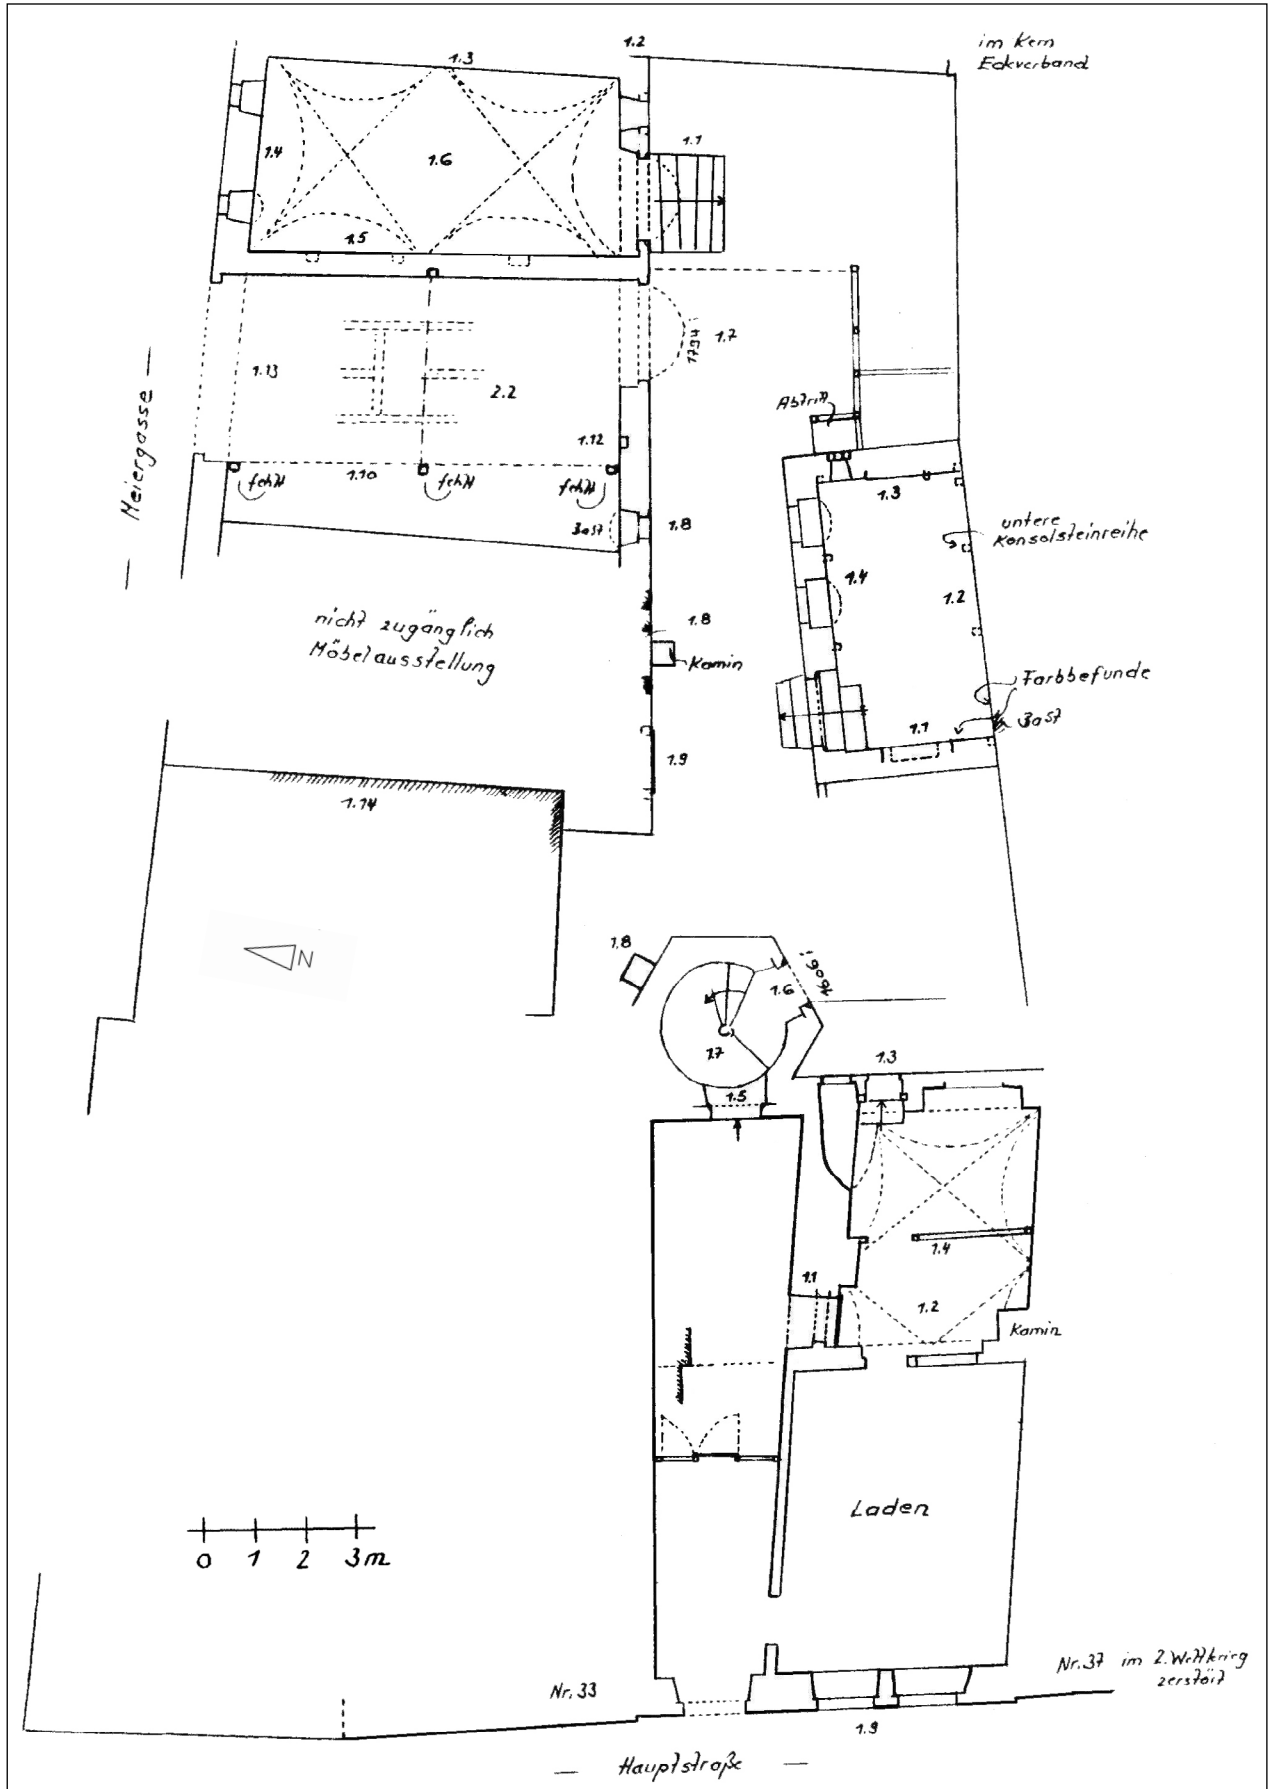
Hauptstraße 35, Grundriss Erdgeschoss, M. 1:150.
